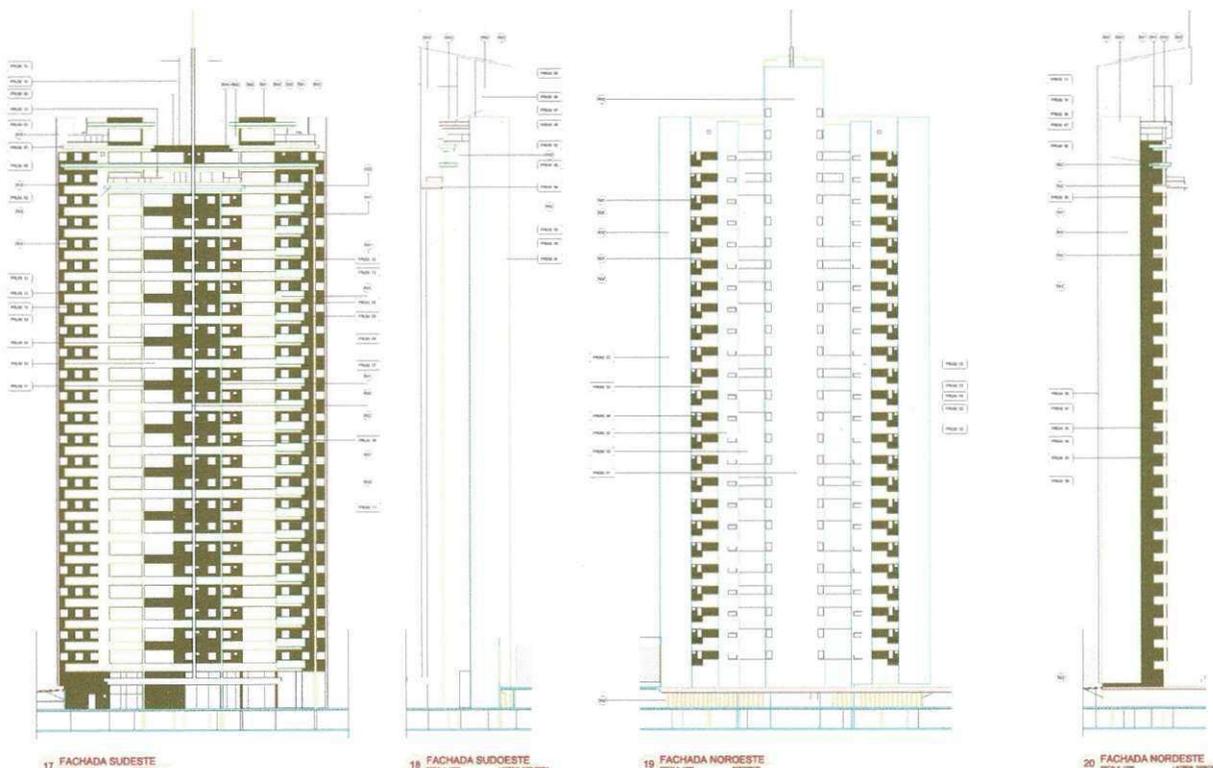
Projeto arquitetônico (Fachadas da torre A).
